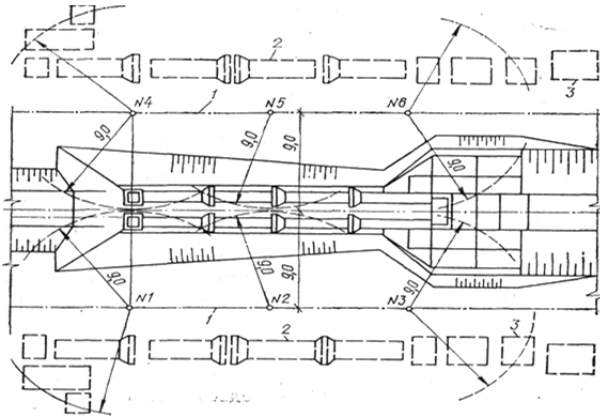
Схема виконання робіт при монтажі шахтного перепаду-регулятора зі збірного залізобетону (план):
